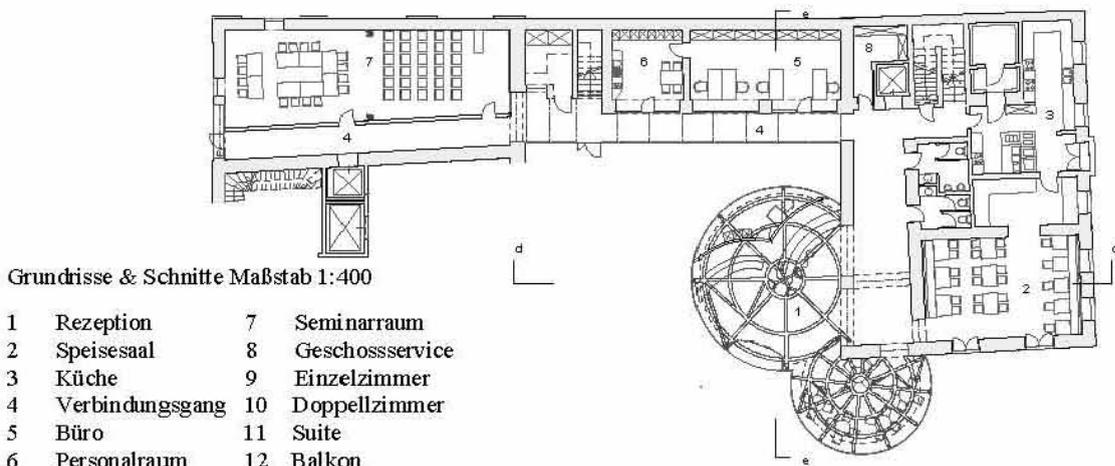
Erdgeschoss Hotel und Seminarräume
